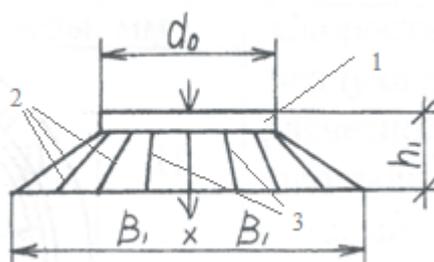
Воздухораспределитель двухструйный шестидиффузорный прямоугольного сечения ВДШп.
